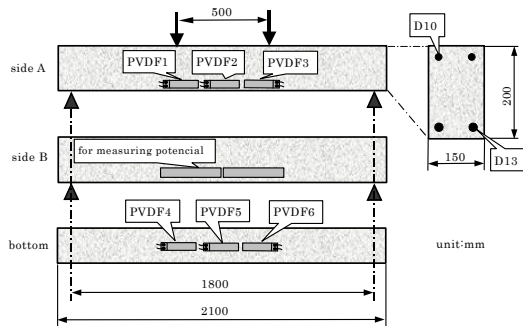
PVDF フィルムセンサによる RC 梁の曲げひび割れ検知性能試験の供試体
